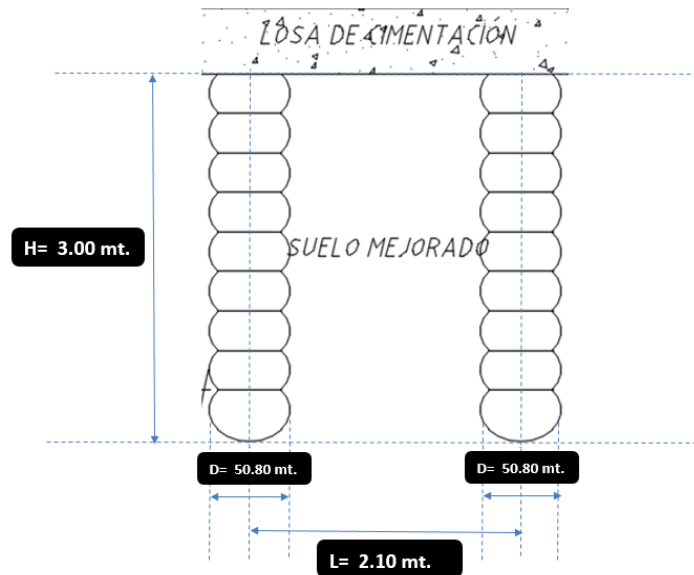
Dimensiones y separación entre pilas típicas de grava compactada, Adaptado de "Elaboración propia", por Obregón y Plascencia, 2018
